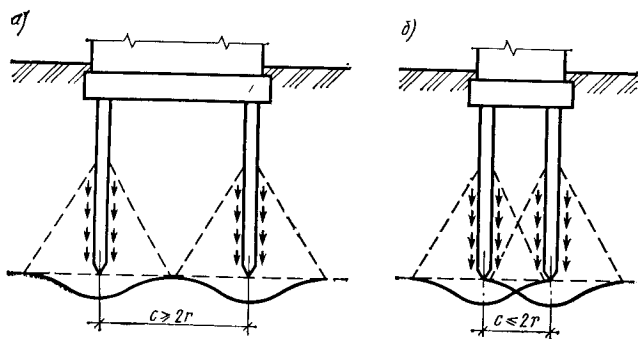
Схема передачи давления на грунт сваями при различном расстоянии между ними:
